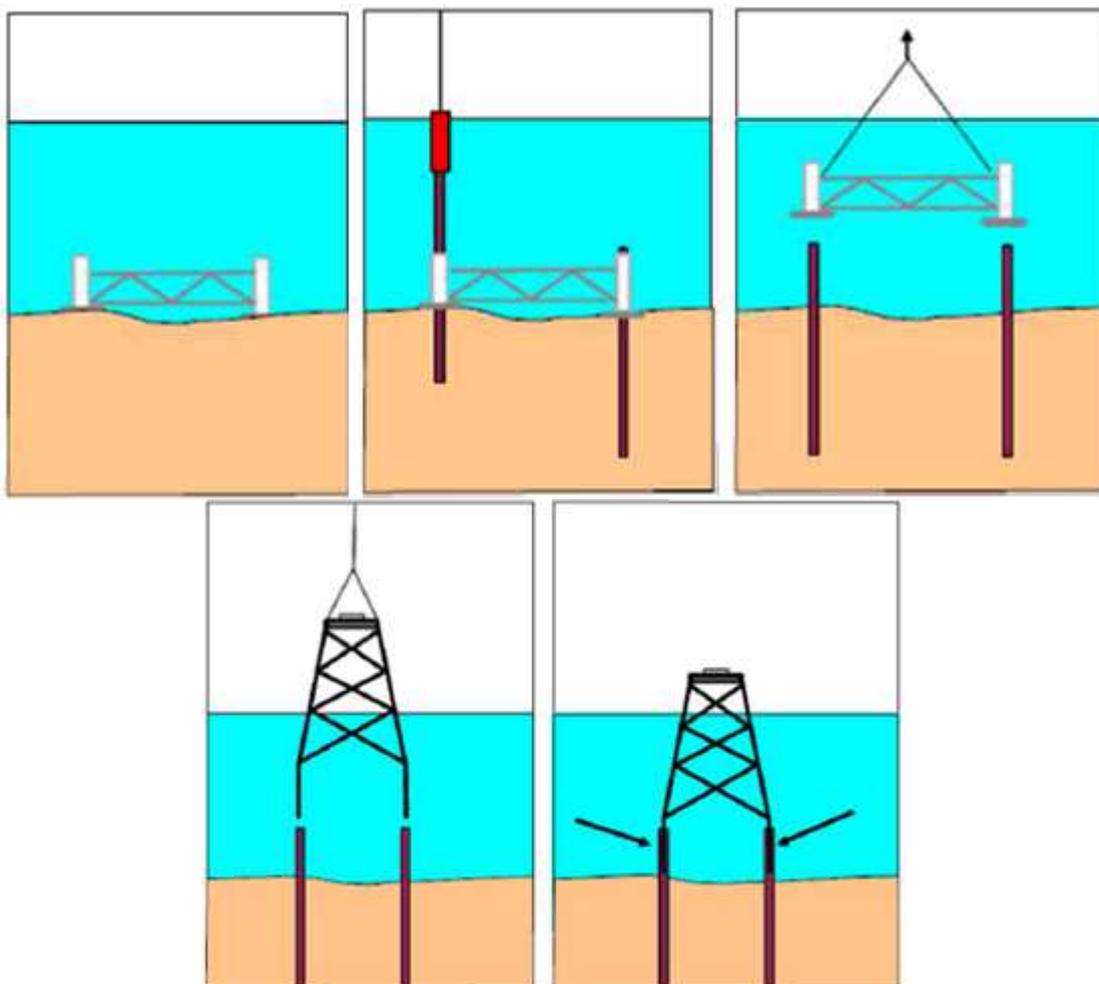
Installazione di jacket sui pali fondari con conseguente grouting finale
